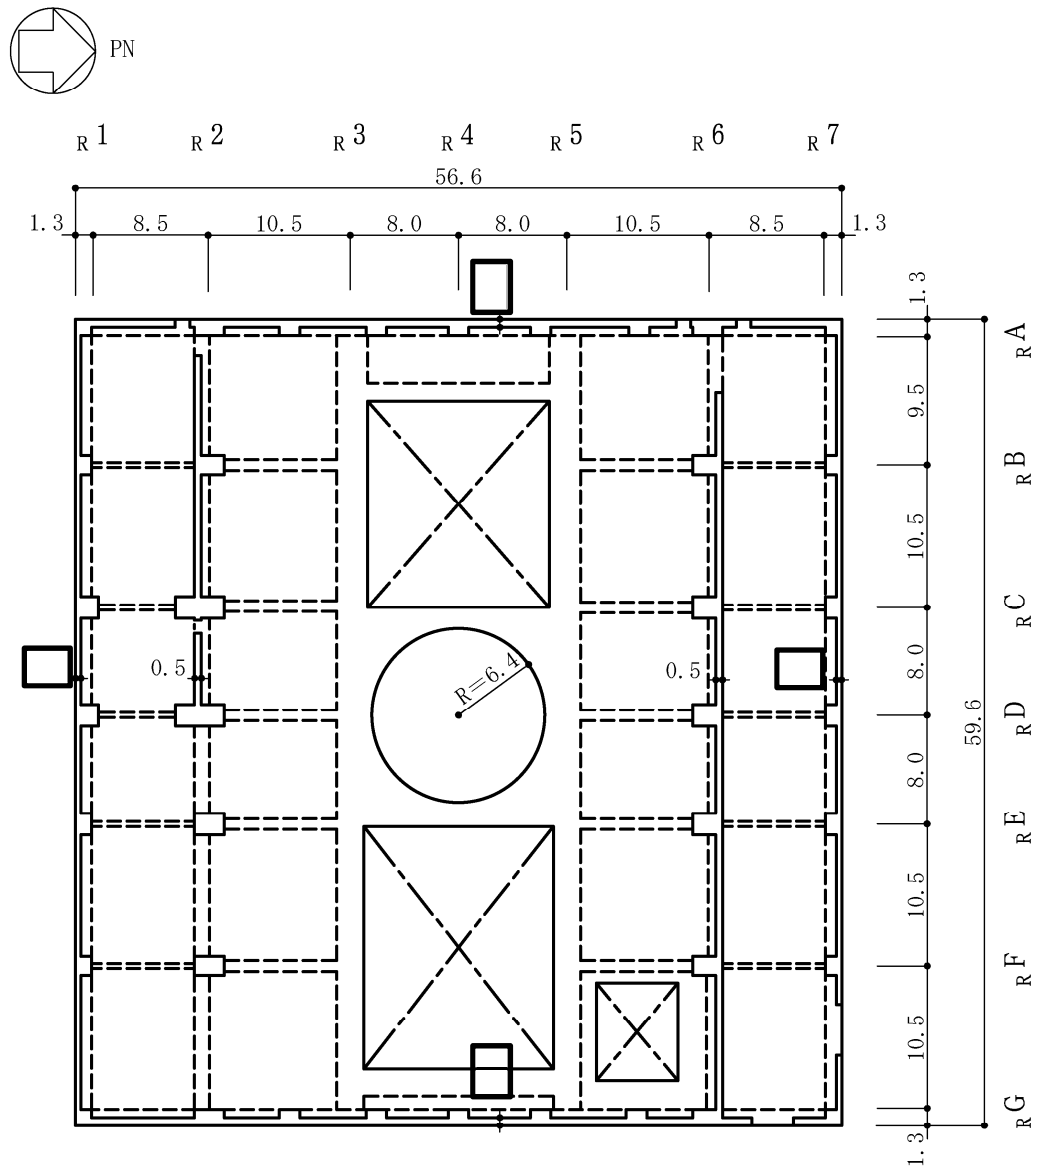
原子炉建屋の概略平面図 (4F, T.M.S.L. 31.7m) (7/9) (単位 : m)
